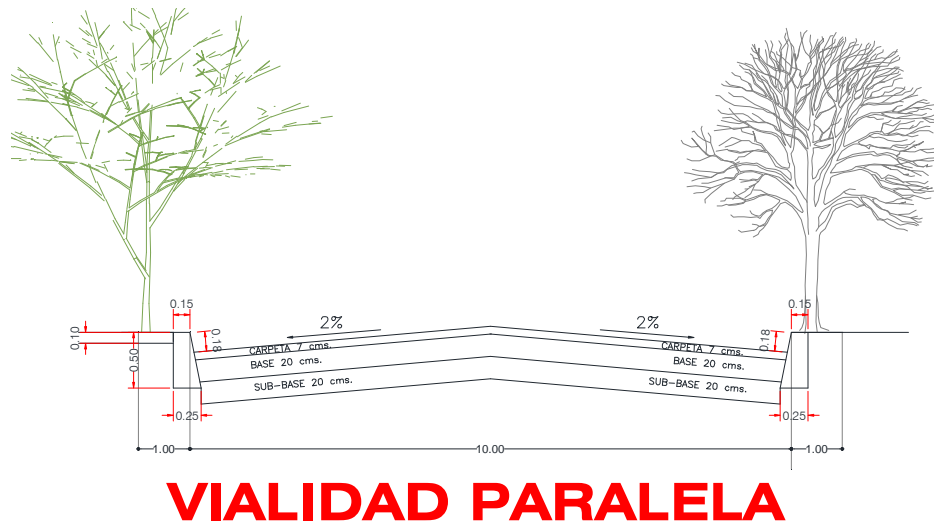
Estructura de Pavimento Vialidad Paralela
